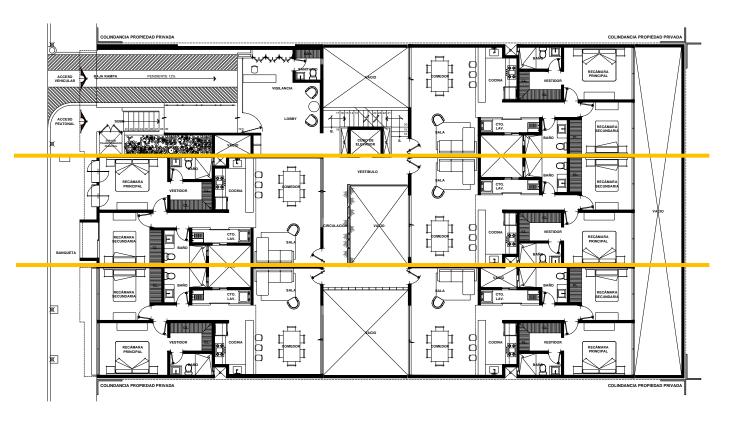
Plantas arquitectónicas de semisótano y planta de acceso. Elaboración equipo de proyectos y diseño de interiores. Año 2019
